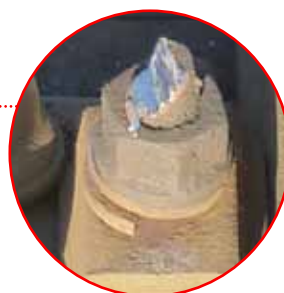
Appareil de dilatation, impact sur un boulon de la face intérieure du rail droit
